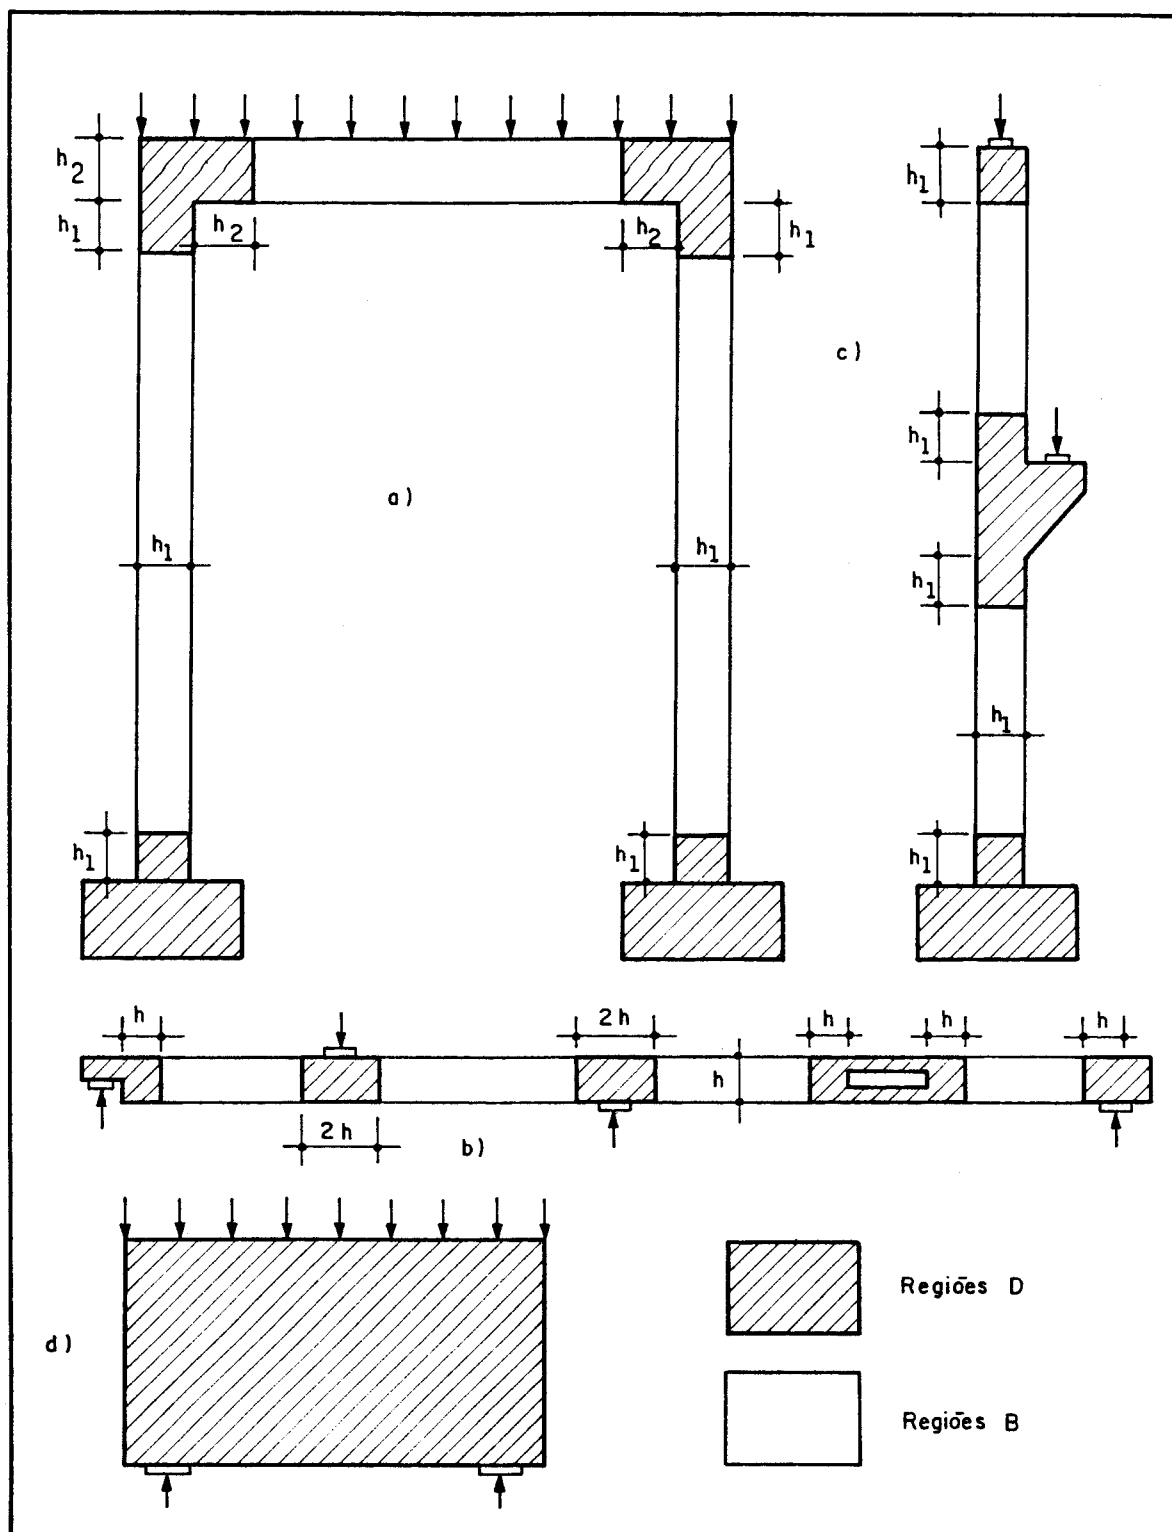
Exemplos de estruturas e suas regiões B e D: a) pórtico; b) viga contínua; c) pilar com consolo; d) viga-parede.
